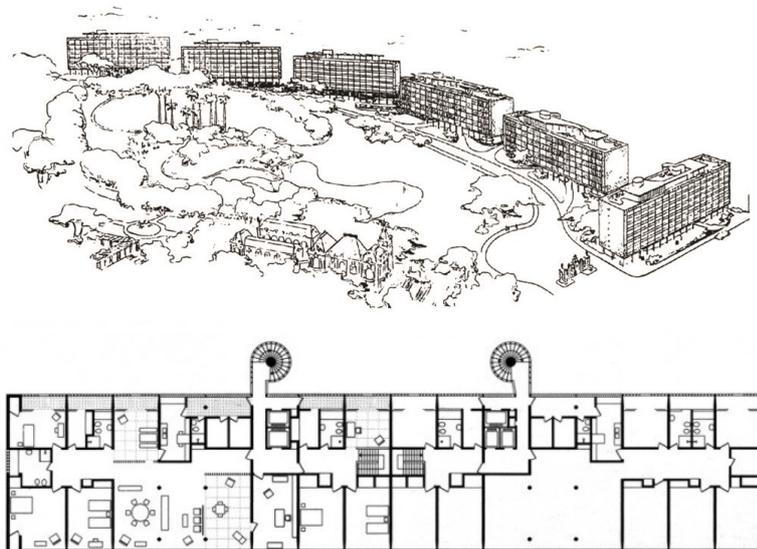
Conjunto Parque Guinle: Perspectiva do conjunto e planta dos 3º, 5º e 7º pavimentos do edifício Nova Cintra (fonte perspectiva: Website Archdaily²⁰ e fonte planta: MINDLIN, 2000).
